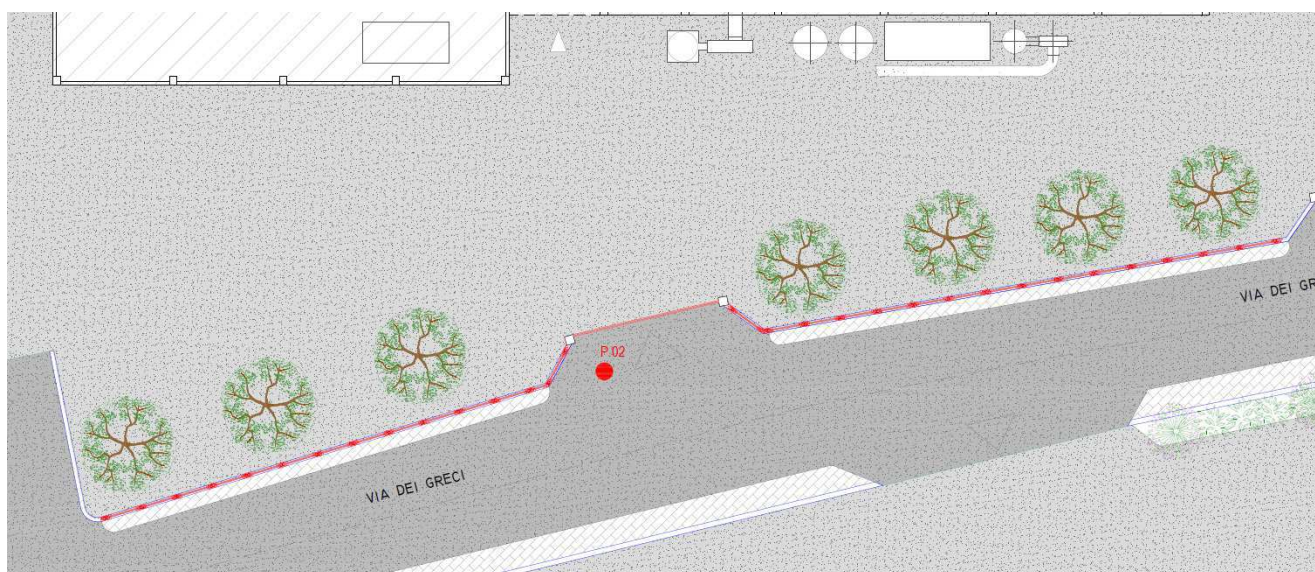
Individuazione planimetrica barriera di contenimento acustico A
